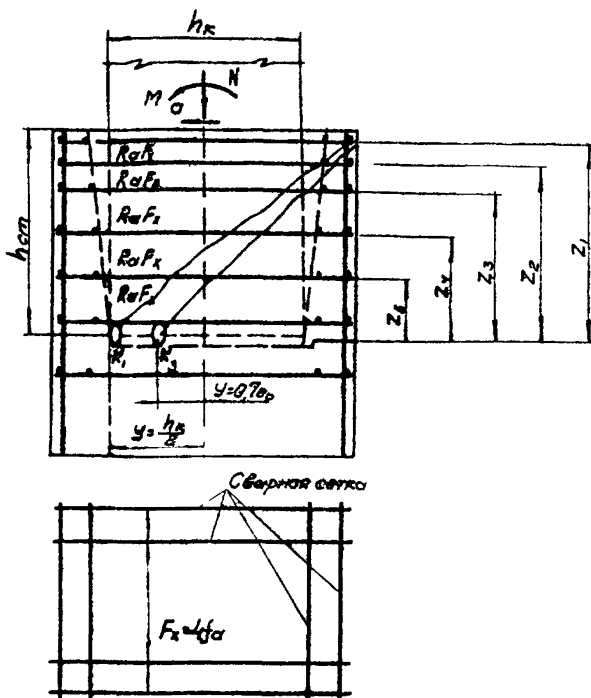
Схемы к расчету поперечной арматуры стенок стакана.
